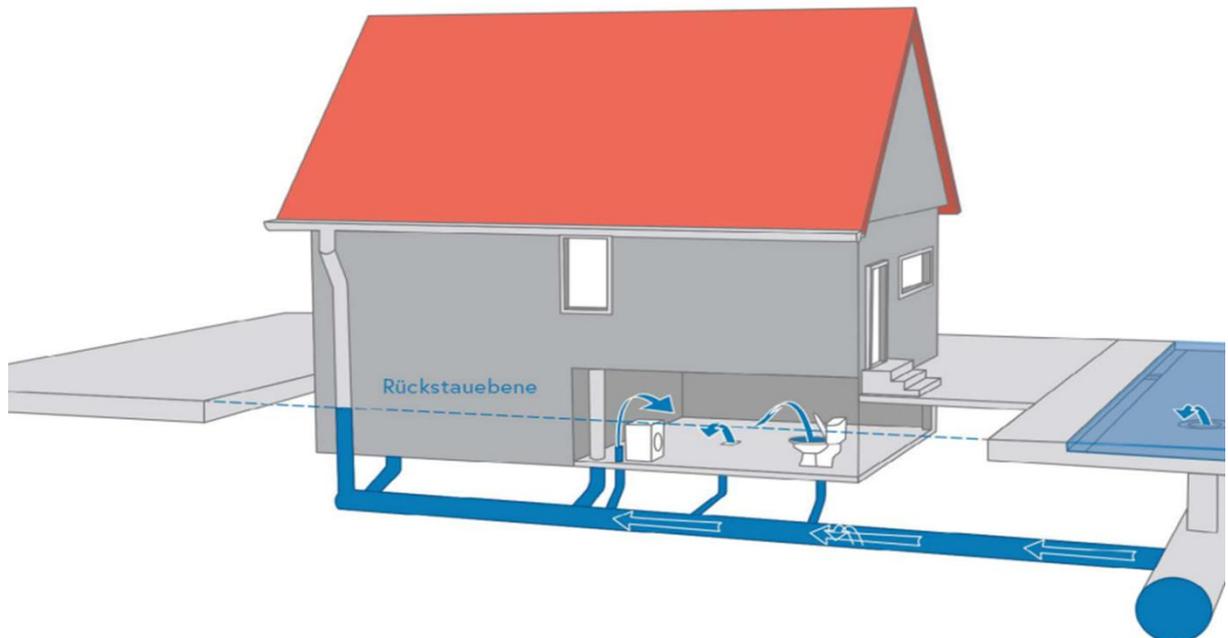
Kanalarückstau und Rückstauenebene, Leitfaden „Wassersensibel planen und Bauen in Köln“ StEB Köln
